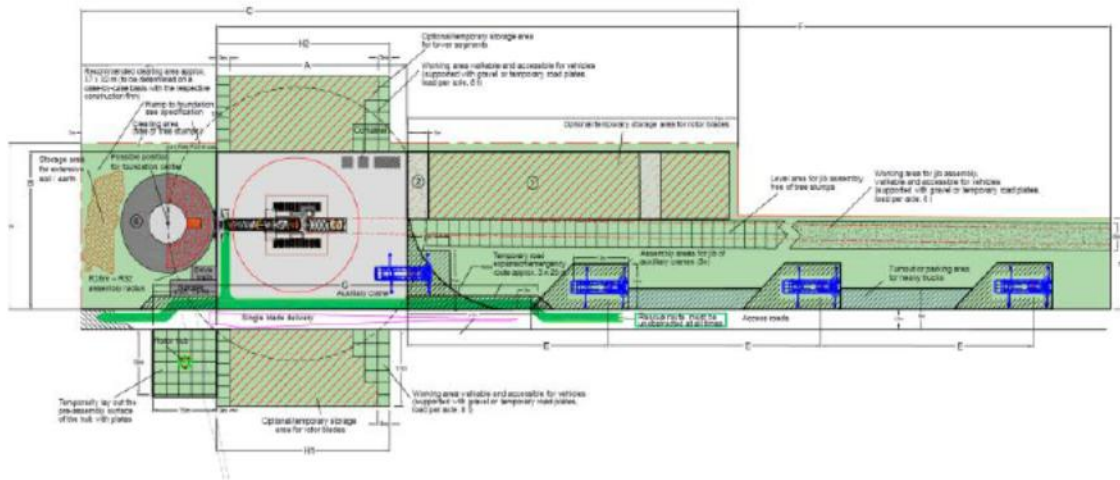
a *Layout piazzola in fase di cantiere
